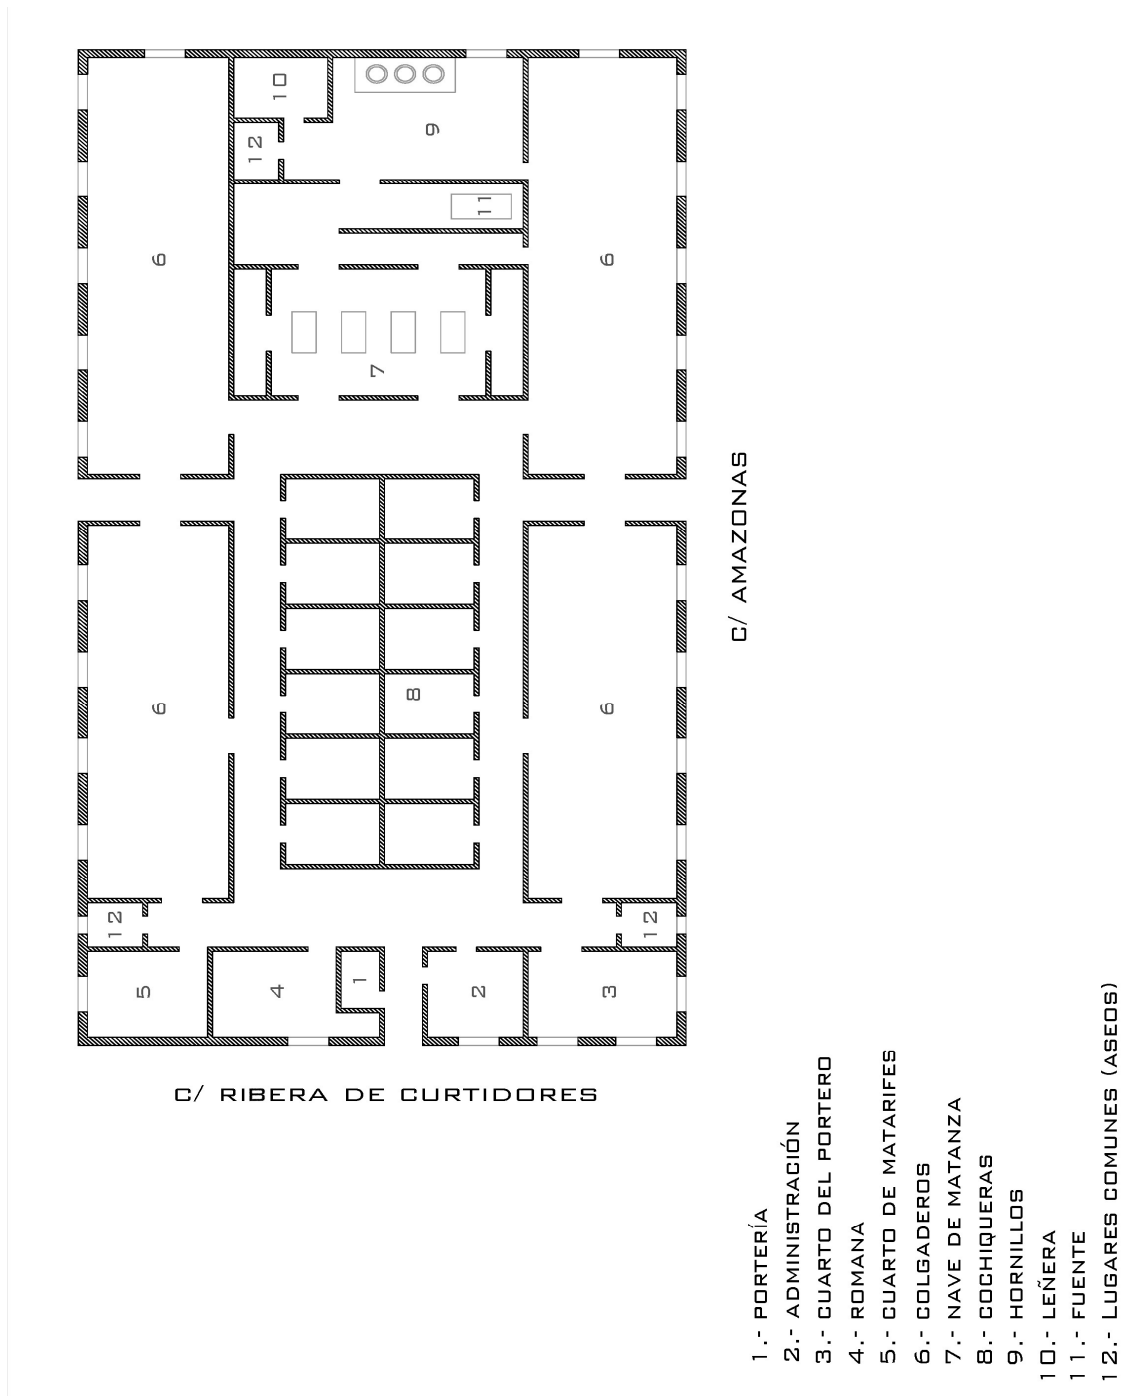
Plano de planta de las instalaciones del matadero de cerdos del Cerrillo del Rastro. 1852²⁹⁶
